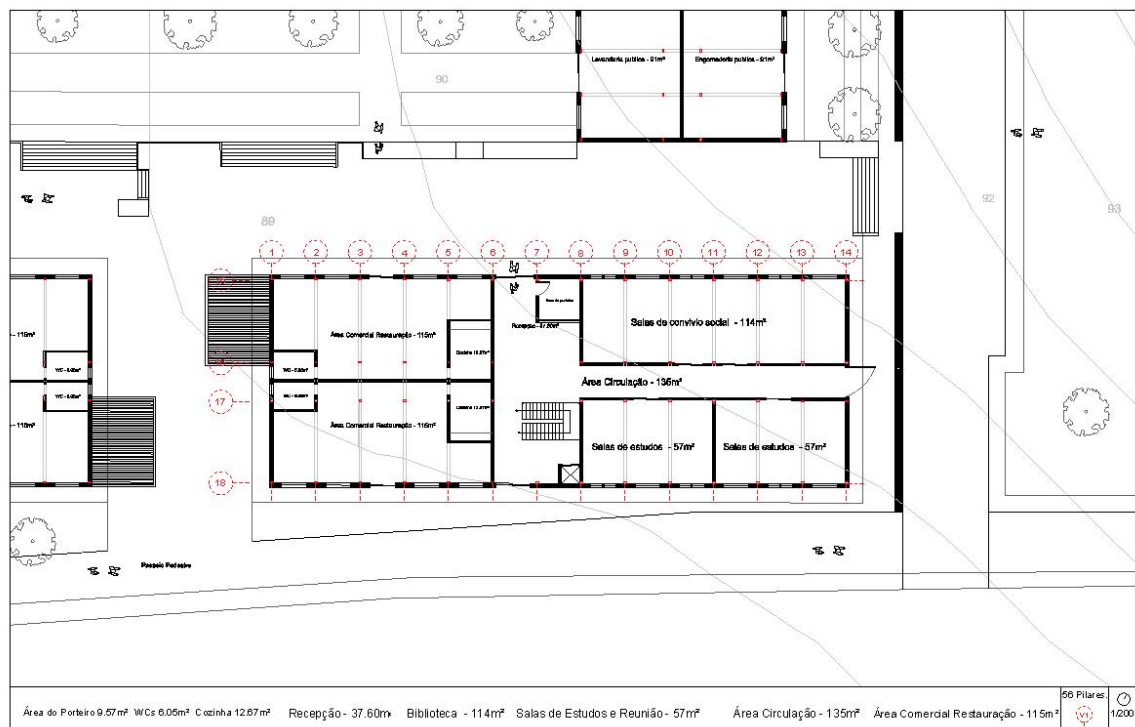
Planta do Térreo 2 Bloco 1/200.
